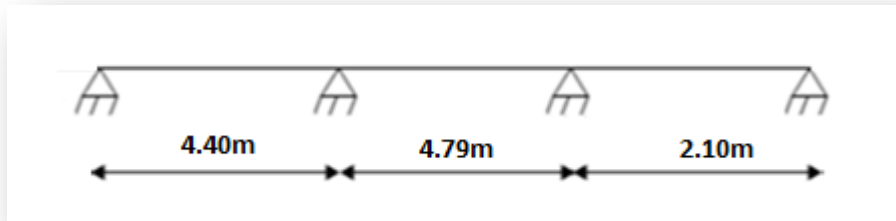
Schéma statique de la poutrelle à 3 travées
